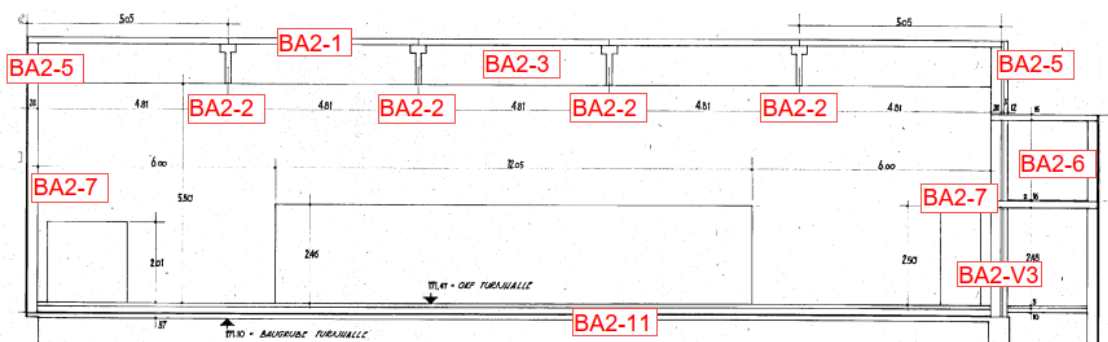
Rückbau – Prinzipdarstellung, Längsschnitt Turnhalle, Ausschnitt aus Anlage 8
